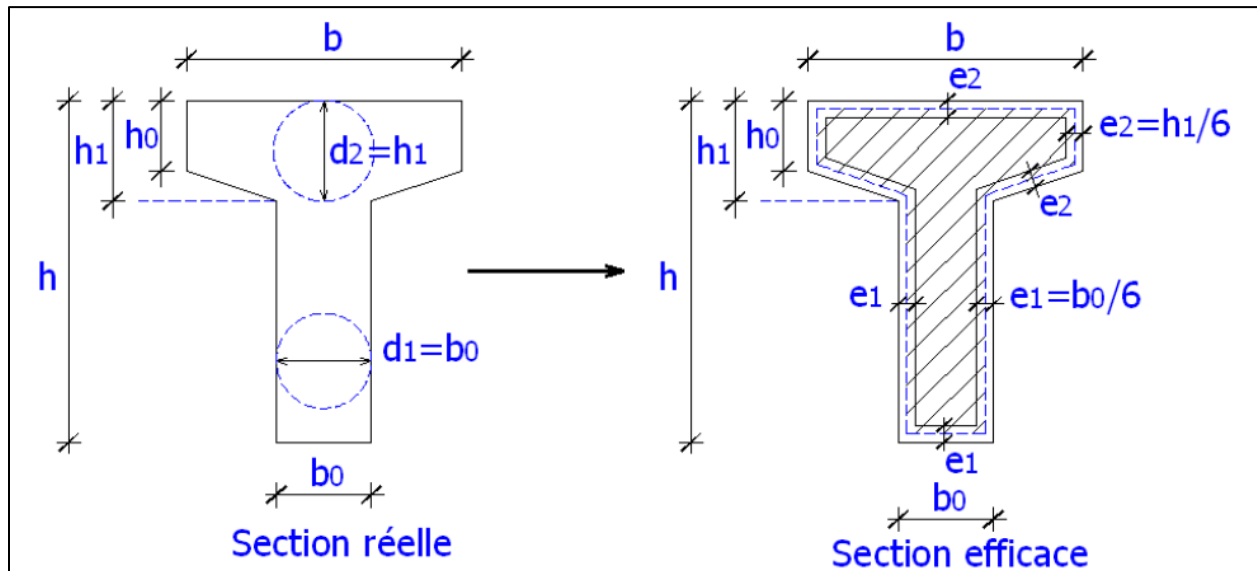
Détermination de l'épaisseur d'une section efficace d'une poutre épaisse.
